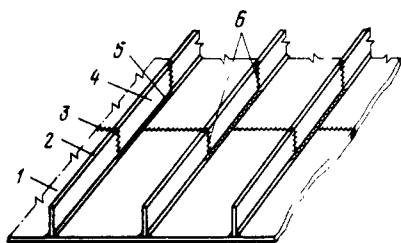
Монтажный сварной стык нижней ортотропной плиты:
